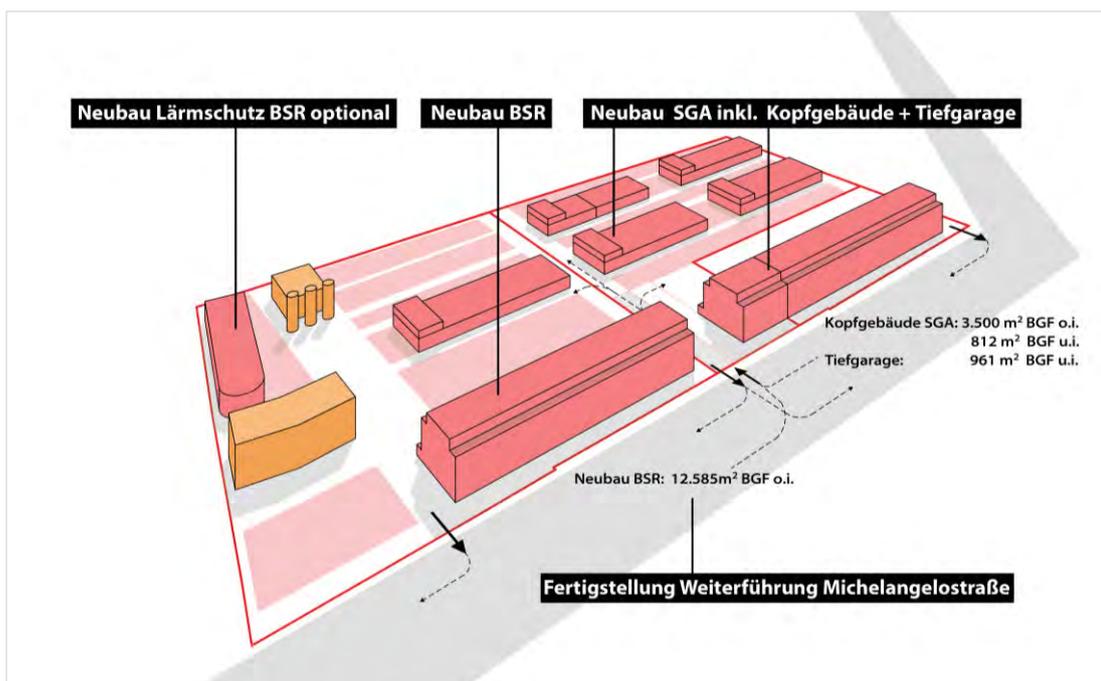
Neubau BSR/ SGA, Fertigstellung Weiterführung Michelangelostraße
